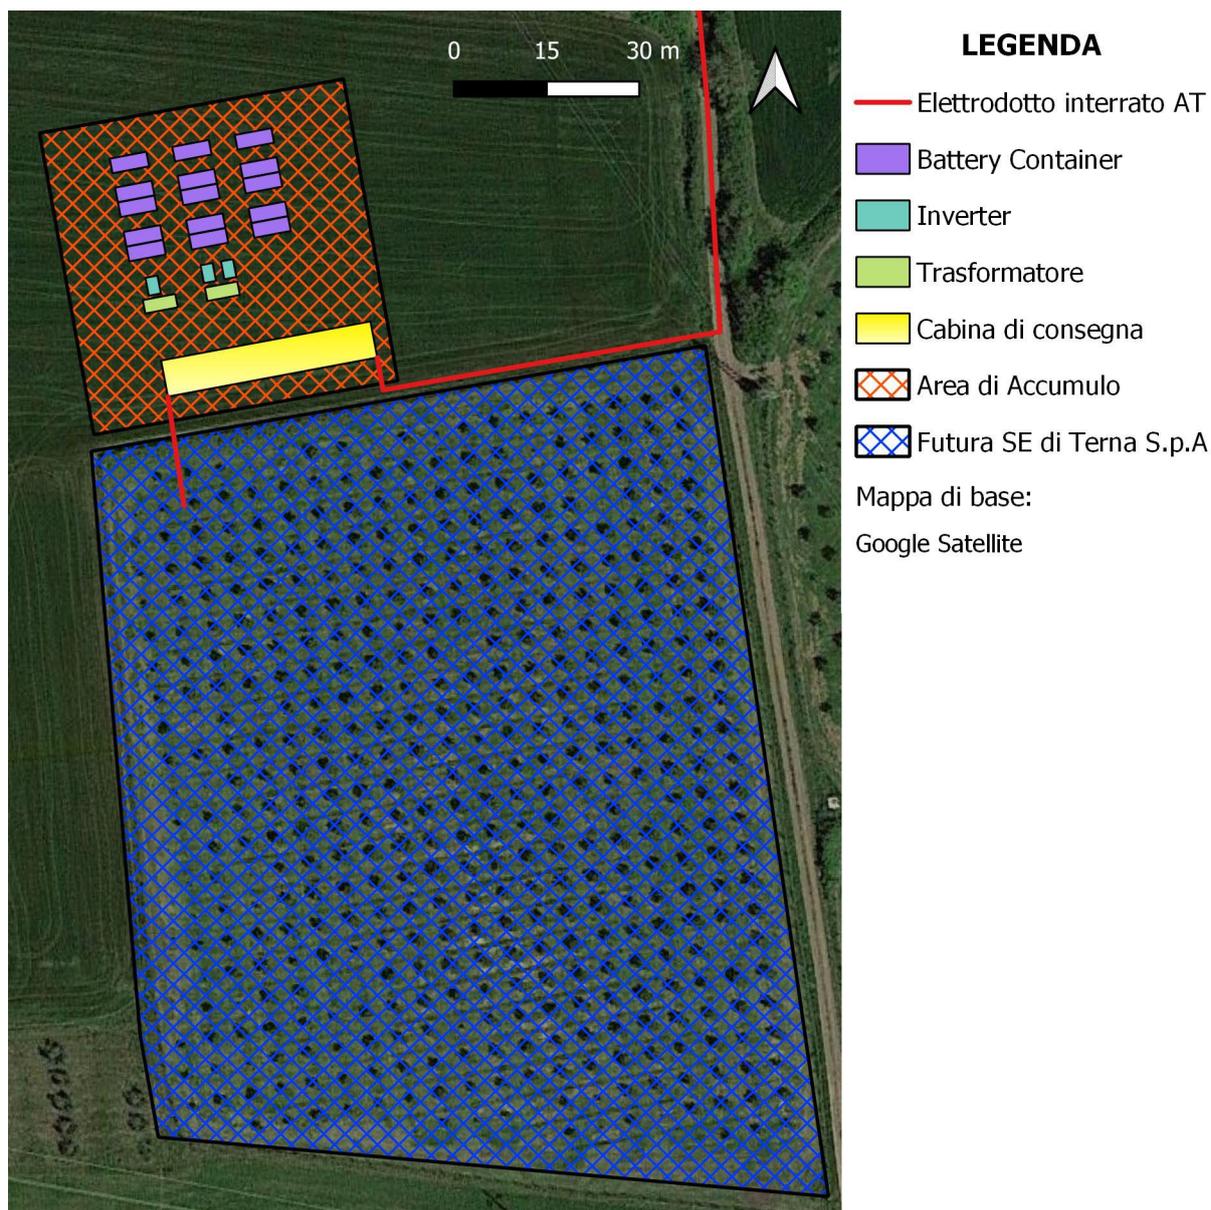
Planimetria dell’Area di Accumulo e della Stazione Elettrica
